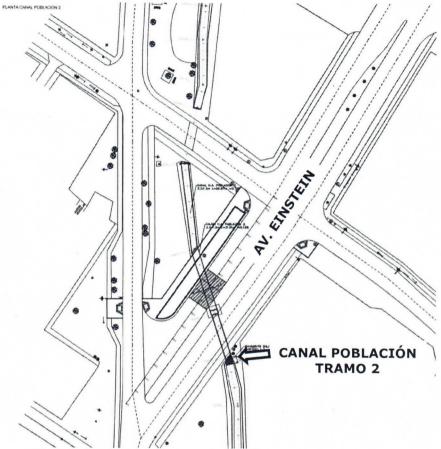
Ubicación Canal Población Tramo 2, Zona Sur.
